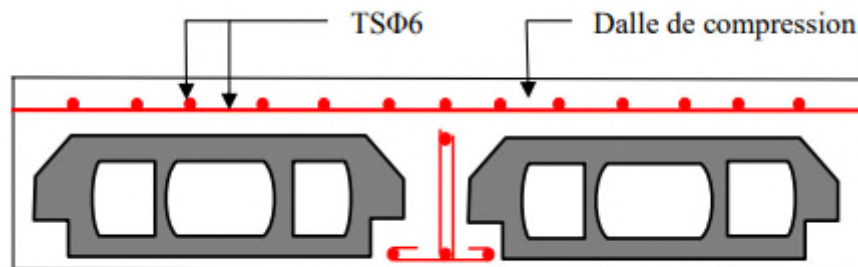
Schéma de ferrailage de la dalle de compression.
